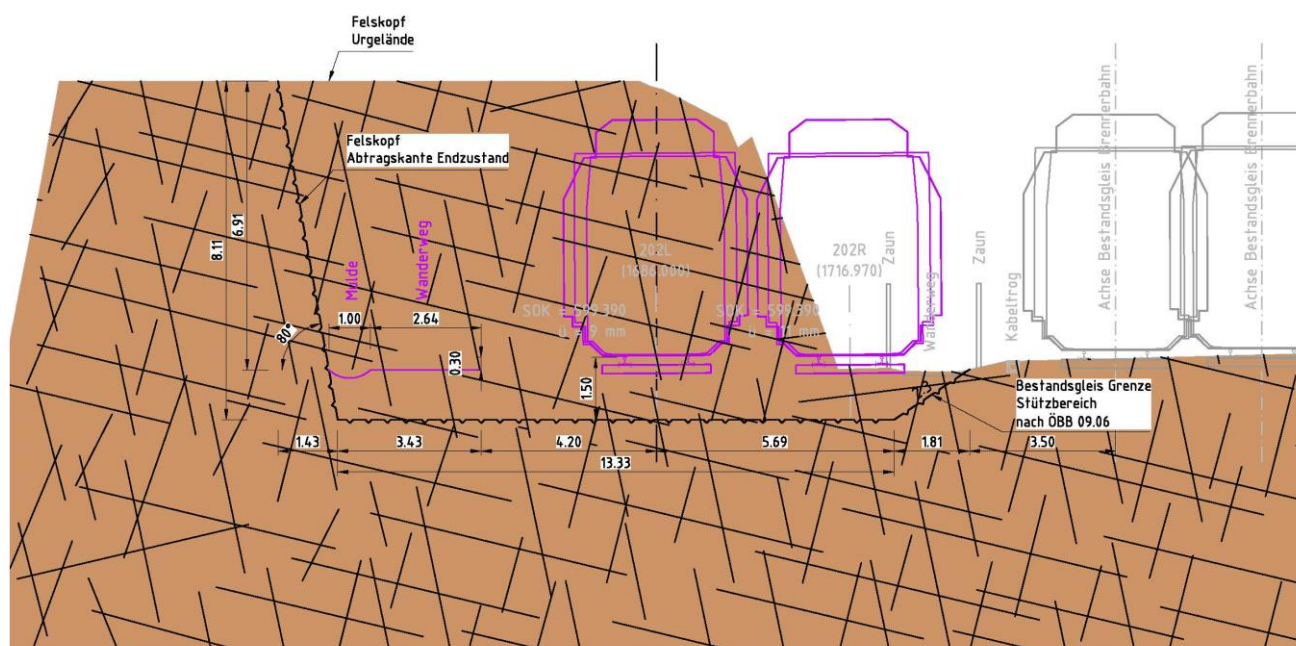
Geologisches Profil km 1,6+86, Übergang Wiltener Tunnel / freie Strecke
